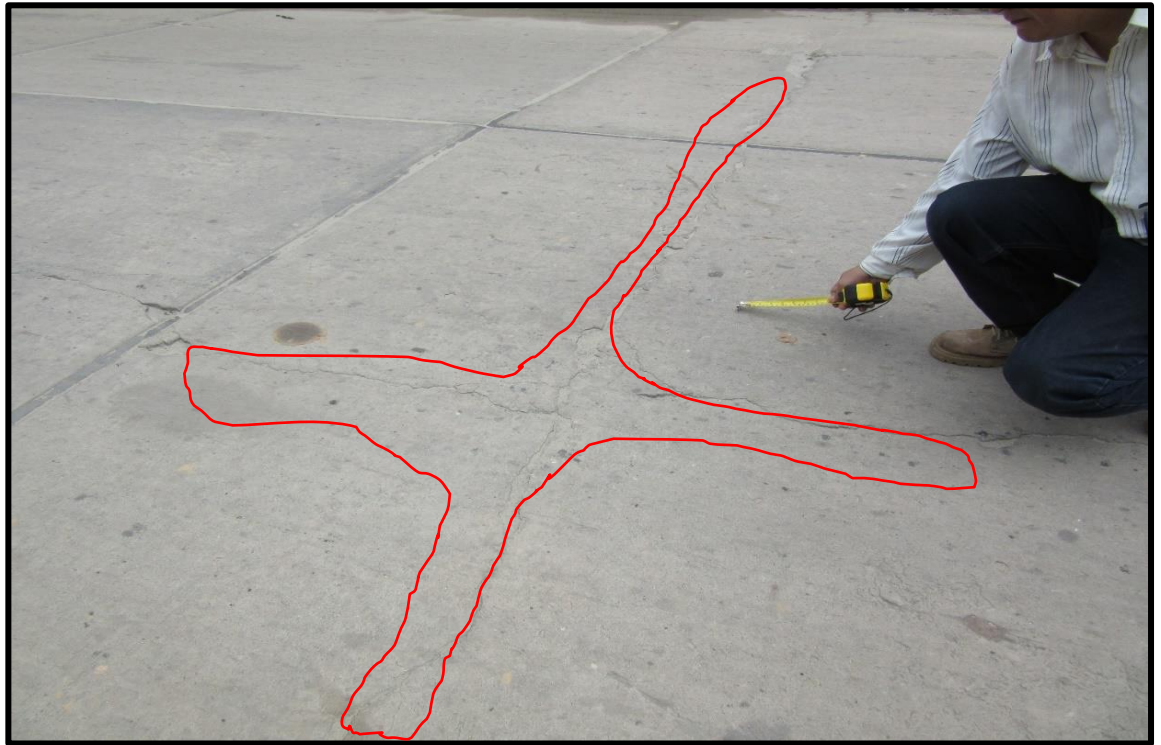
En la vista se observa Fisuras de Grietas Lineal Longitudinal y Transversal de Baja Severidad en el Jirón Trujillo 13va. Cuadra
